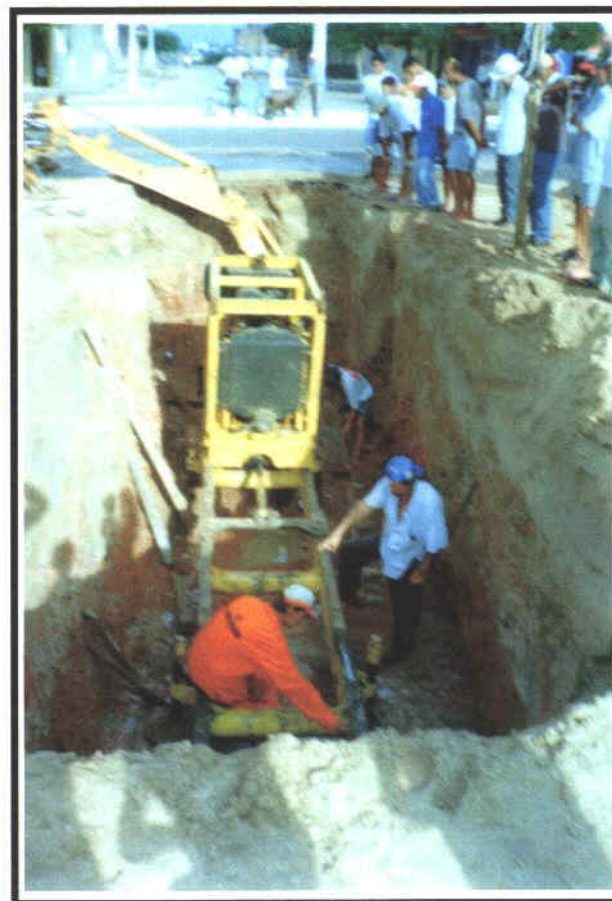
Detalhe da escavação pelo método não destrutivo.
